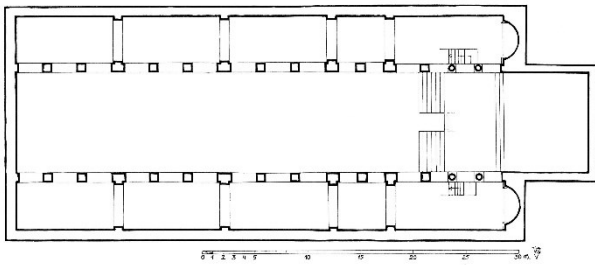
Grundriss von St. Ludgeri in Helmstedt
